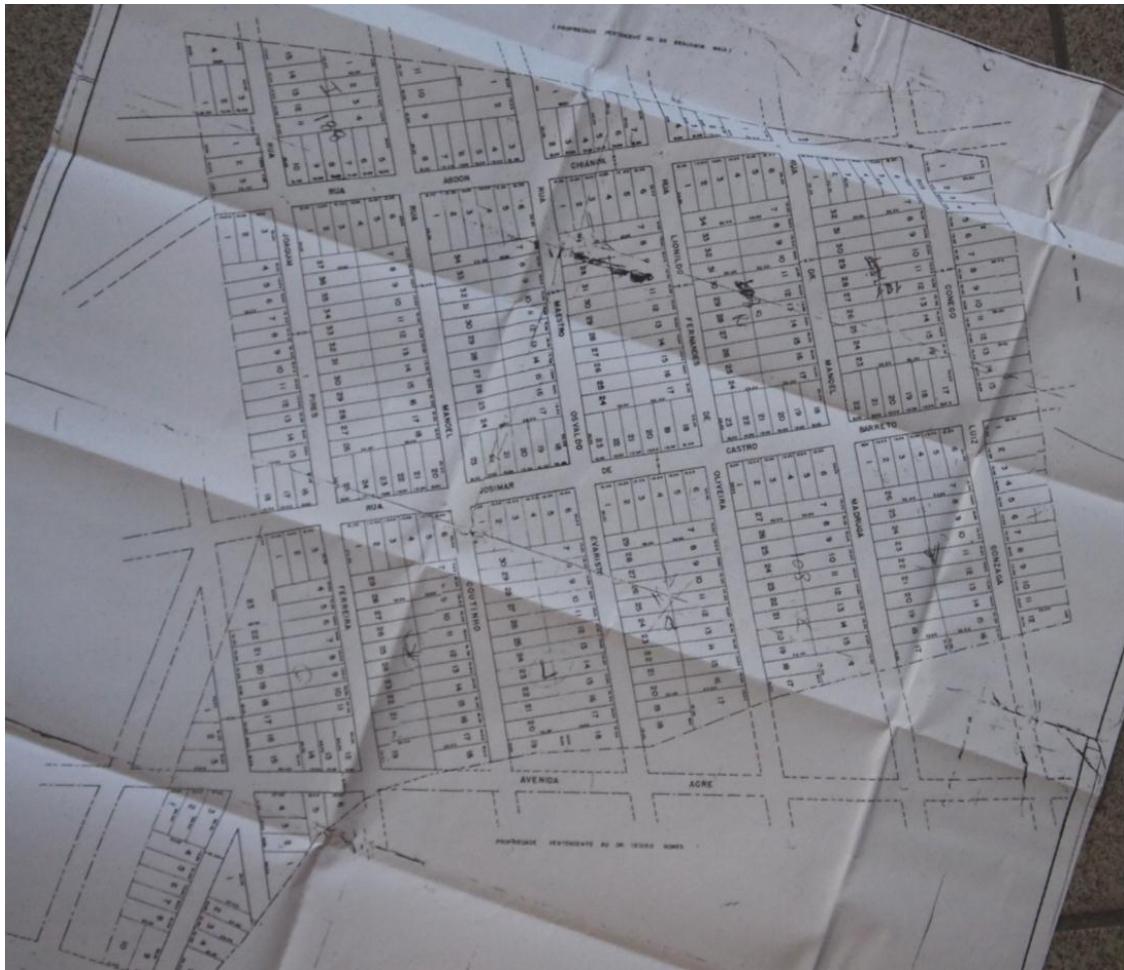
Cópia (1975) do projeto do Loteamento São Joaquim. Fonte: PMJP.
